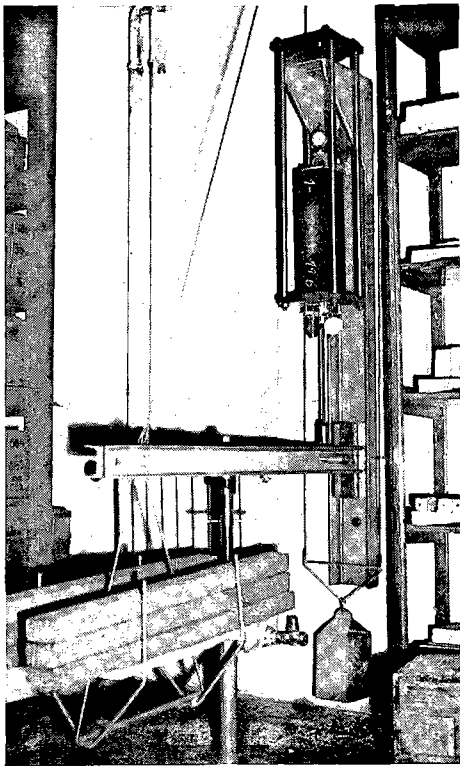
Anordnung einer Langzeitprüfung der Kohäsion des Kunststoff-Betons mit der Stahlbewehrung
